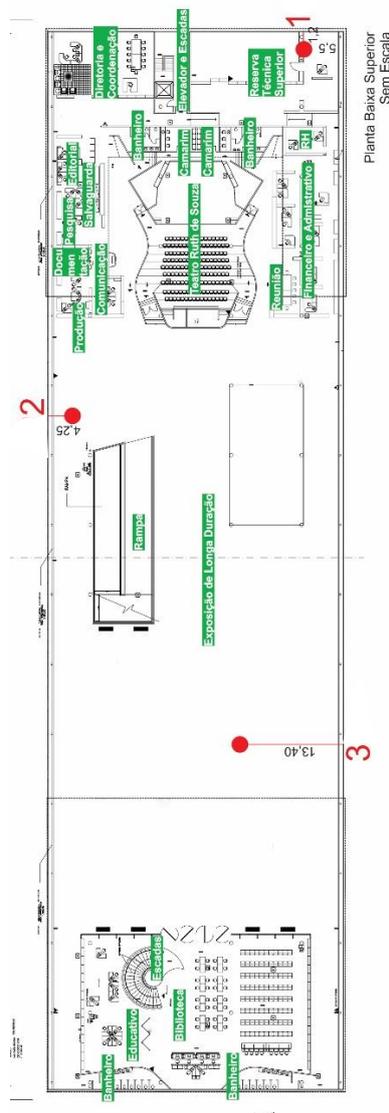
Planta baixa do pavimento superior do Museu Afro Brasil com a localização dos três dataloggers. Fonte: autor, 2020
